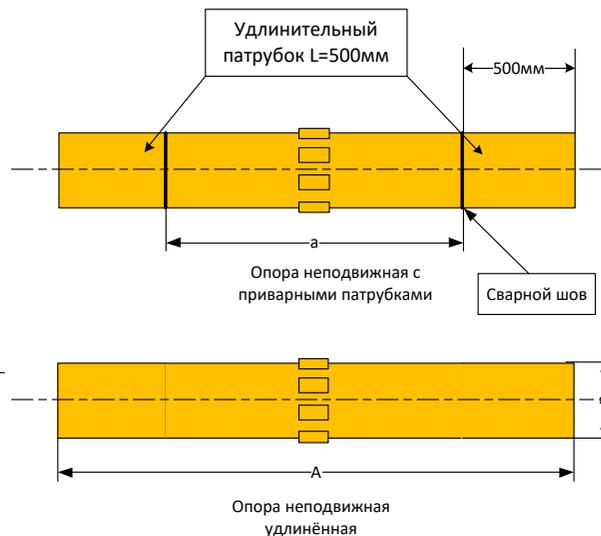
опора неподвижная с приварными патрубками
